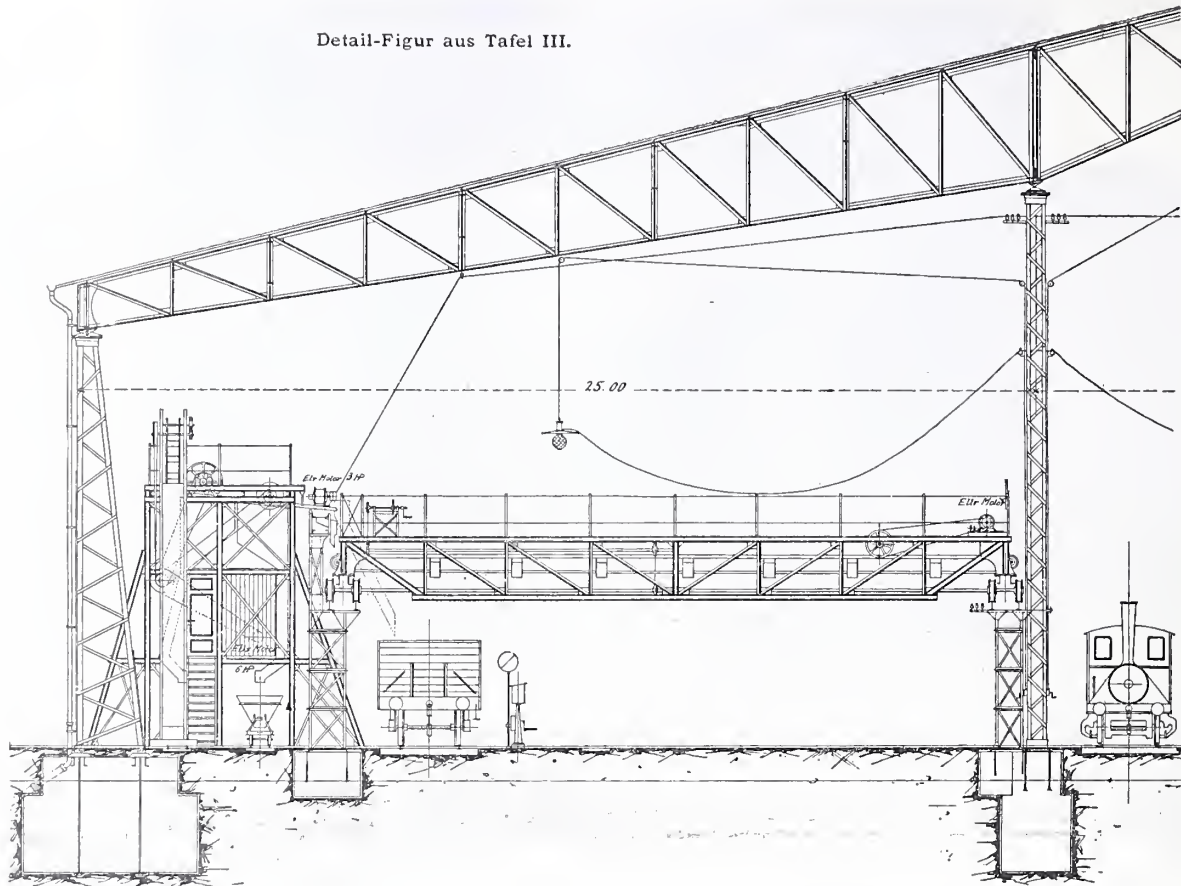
Kokeaufbereitungsanlage mit Längs- und Quertransport. Querschnitt A-B. 1:200.
